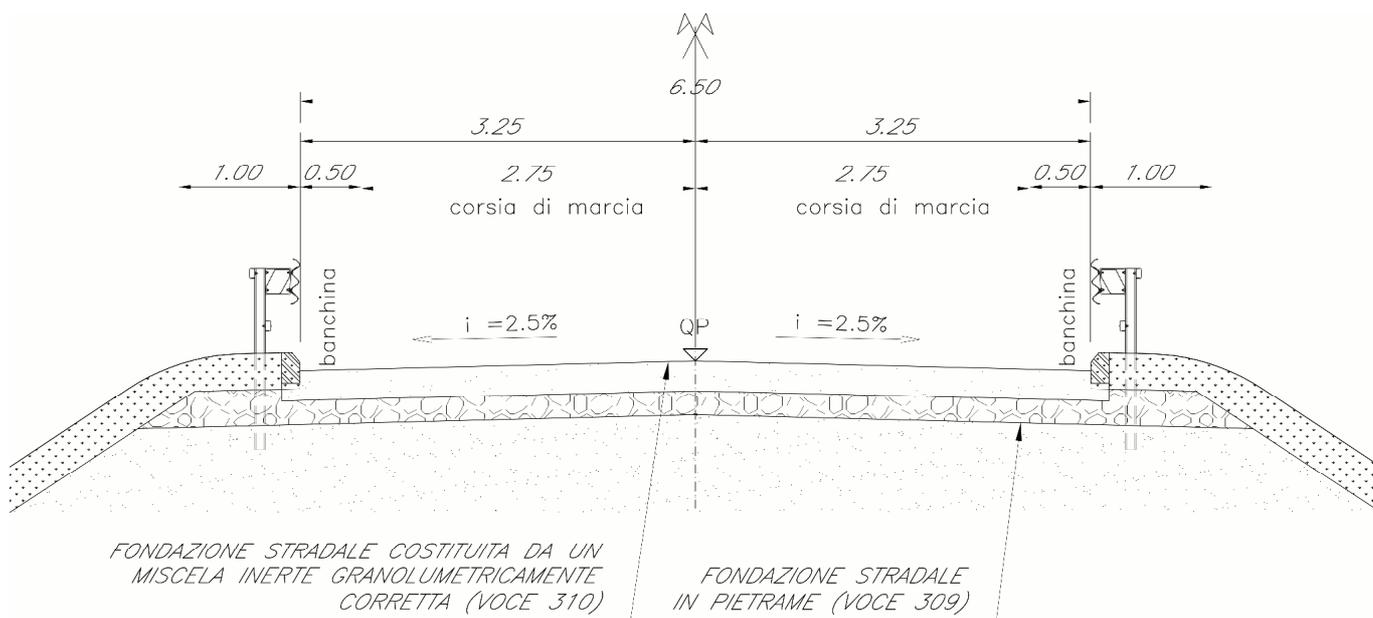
SEZIONE TIPO IN RILEVATO CON PAVIMENTAZIONE IN MACADAM
